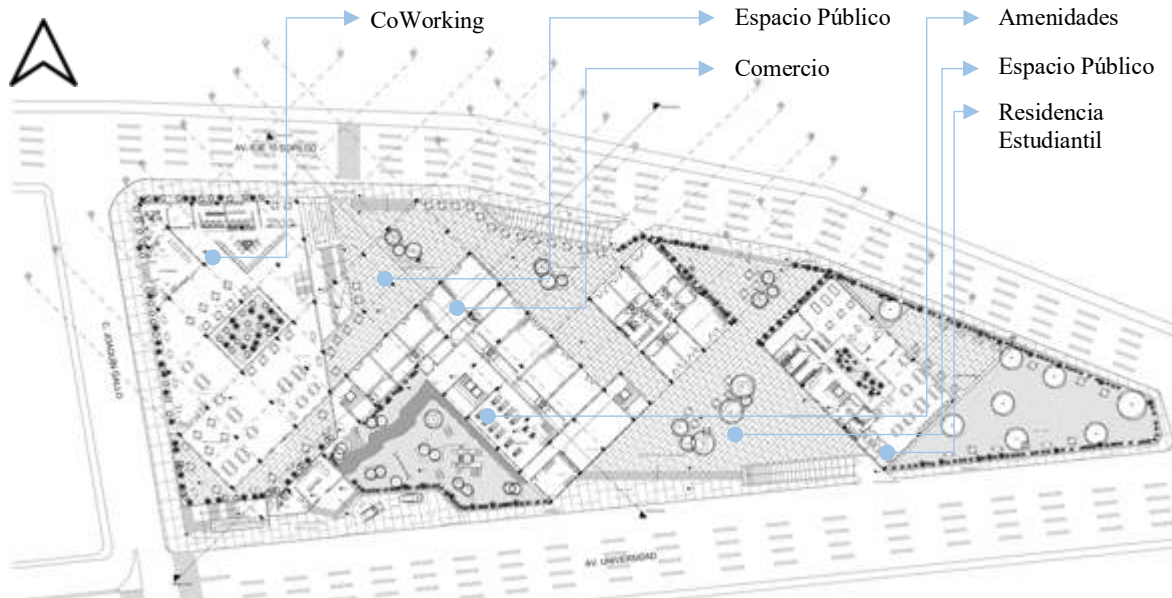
Planta baja arquitectónica de conjunto. Fuente: Elaboración propia.
